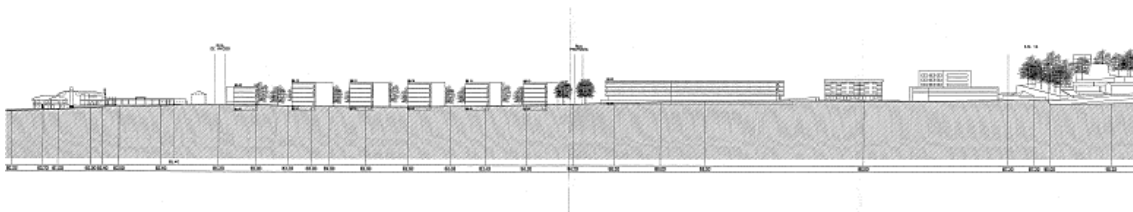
Perfis do Plano de Pormenor, João Álvaro Rocha
